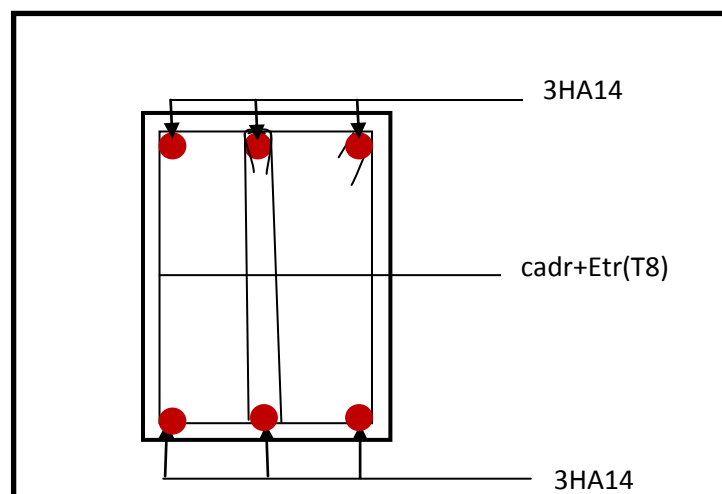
Ferraillage en travée d'une poutre secondaire
